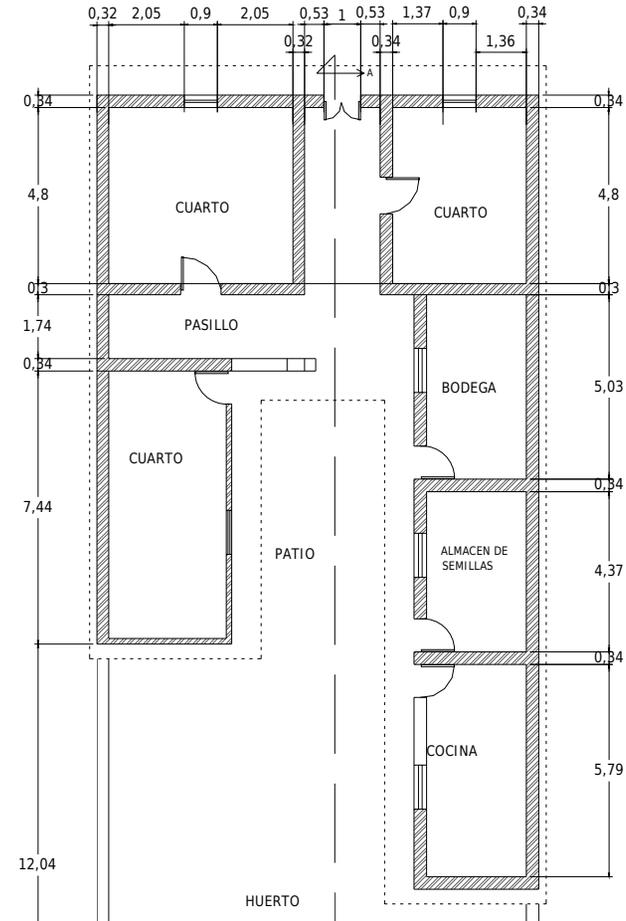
PLANTA ARQUITECTONICA CORRESPONDIENTE A LA FICHA No. 27.
